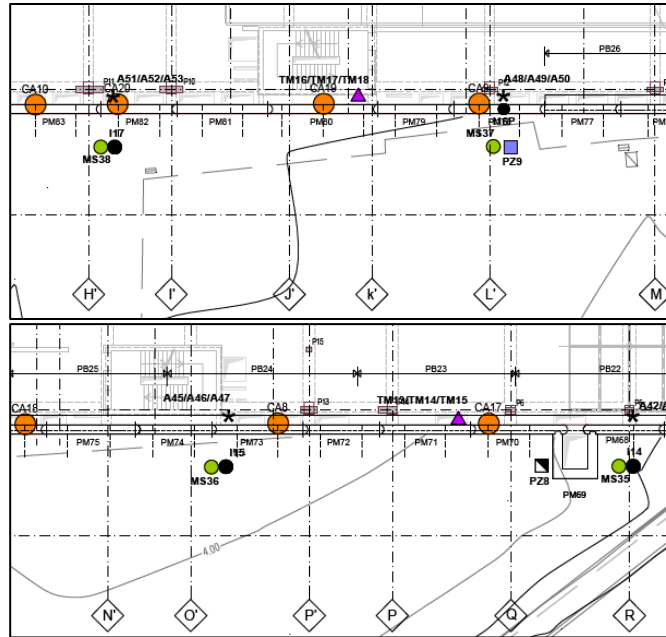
Planta esquemática com a localização (sem escala) dos instrumentos da zona de estudo
